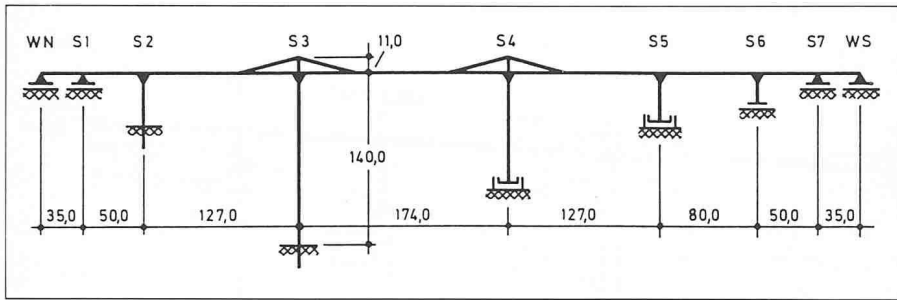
Ganterbrücke, Tragsystem und Lagerung
